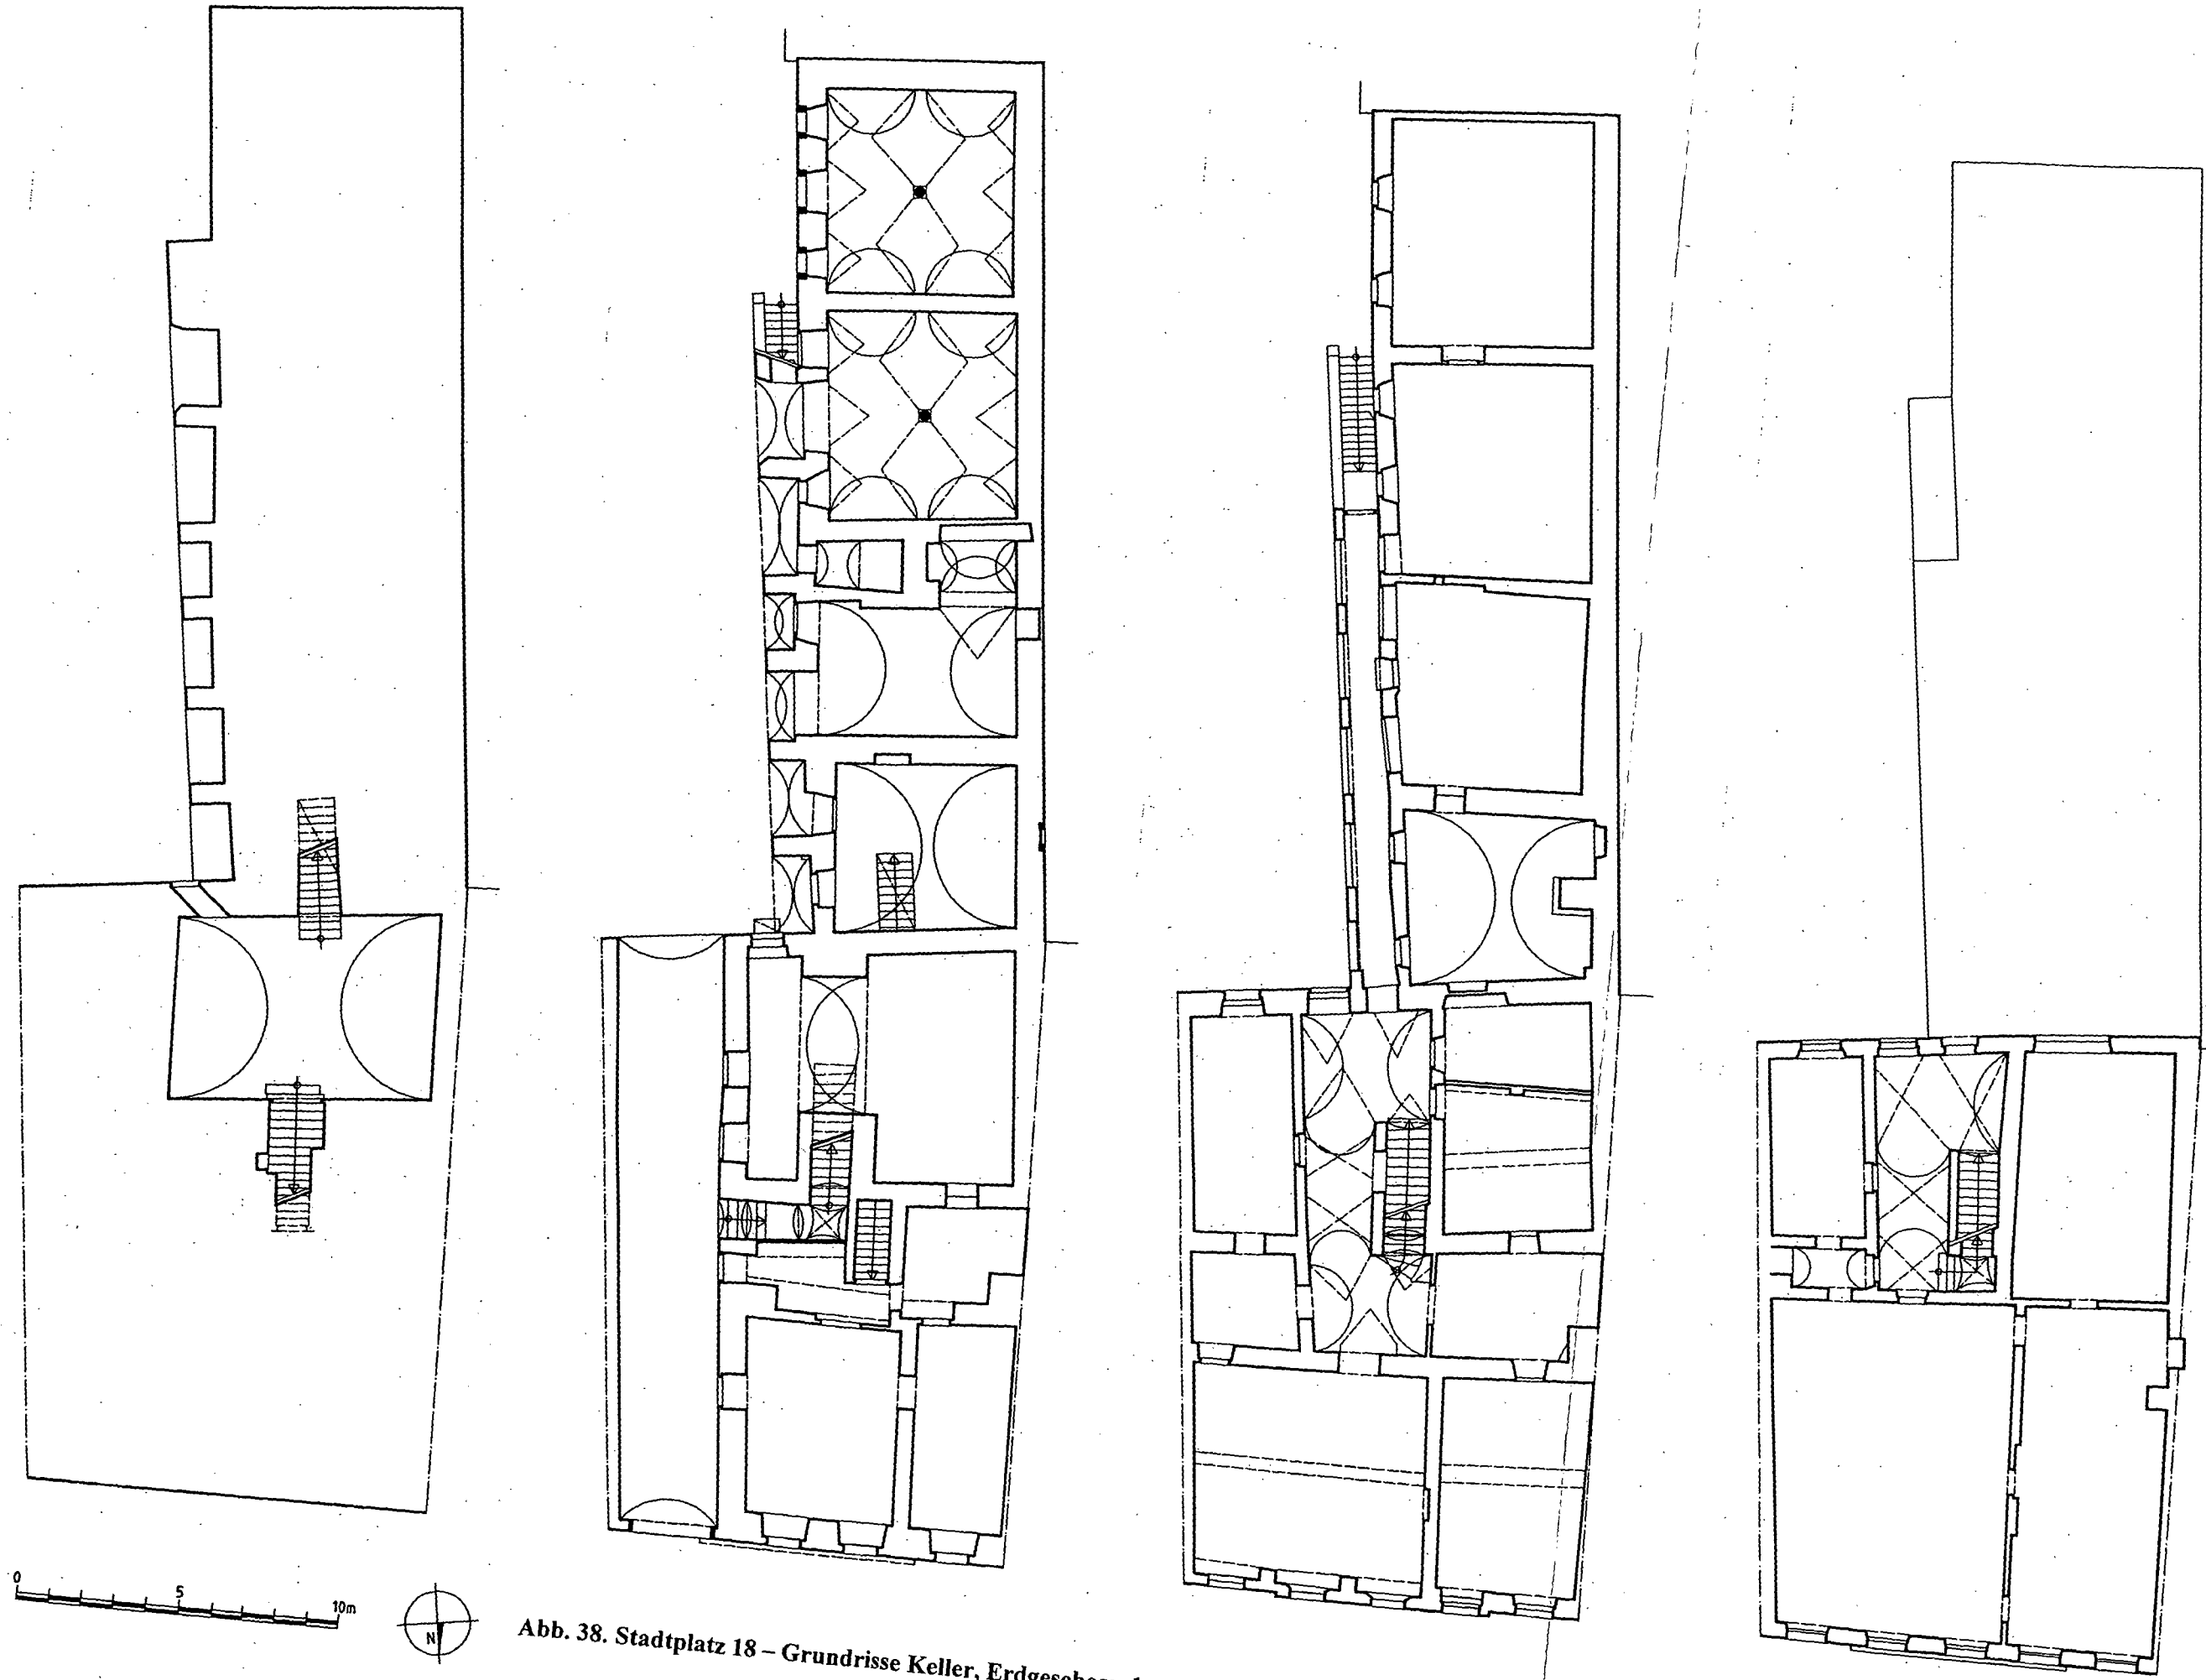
Stadtplatz 18 – Grundrisse Keller, Erdgeschoss, 1. und 2. Obergeschoss (1:200).
